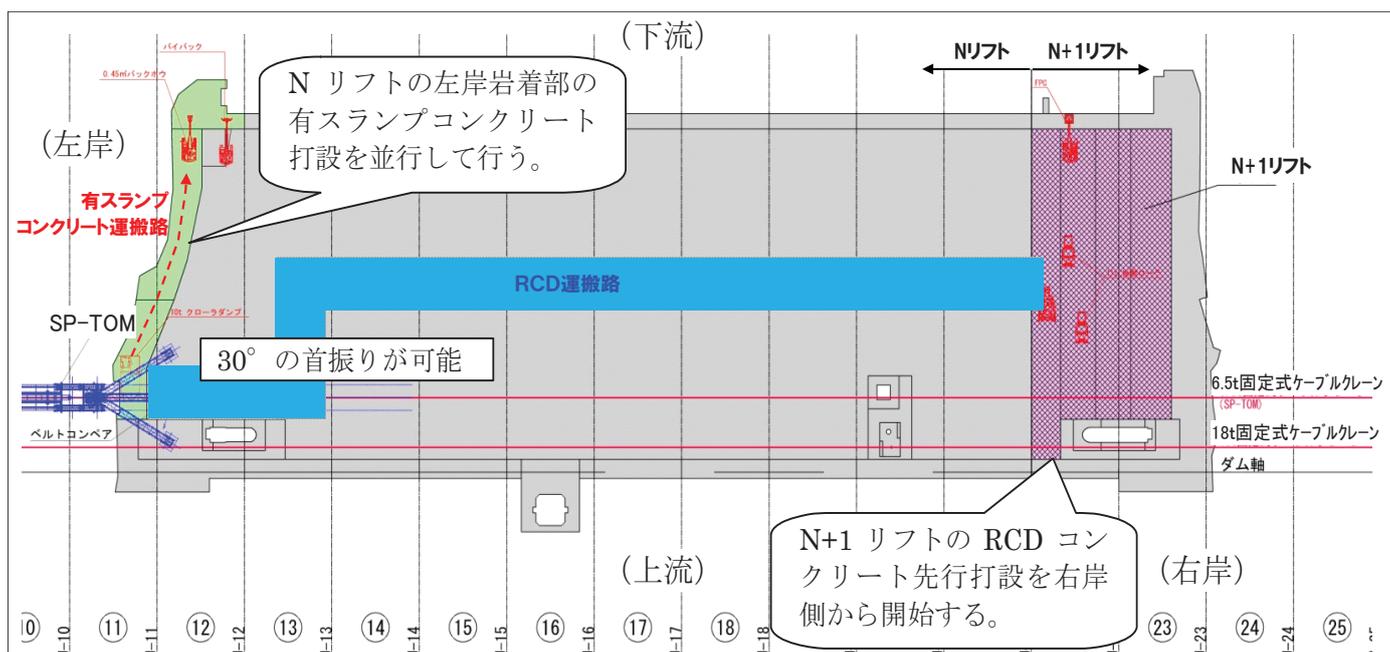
インクラインベルトコン導入による2リフト連続施工イメージ
